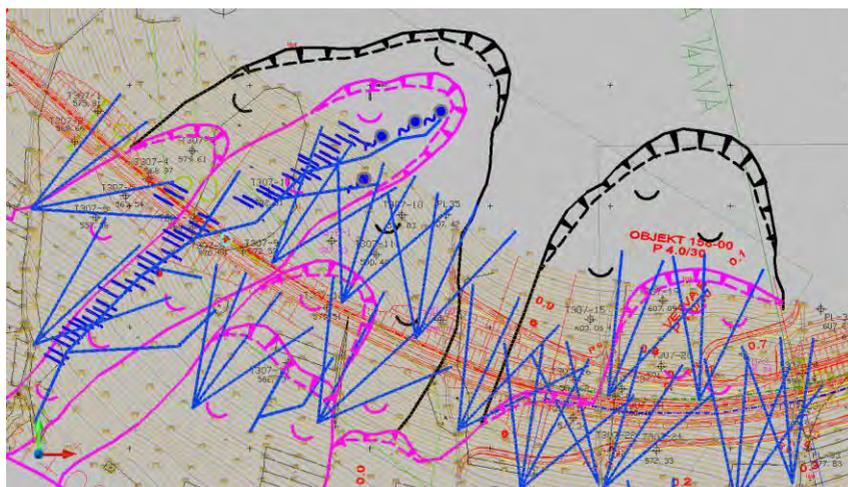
Оползни по трассе автомагистрали (черные – затухшие; красные – потенциальные), обводненные участки и размещение горизонтальных водопонизительных скважин
